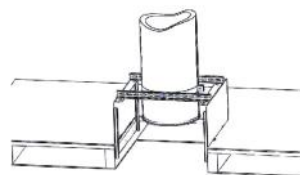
Collier de soutien réhaussé réf. 121 sur plancher bois
